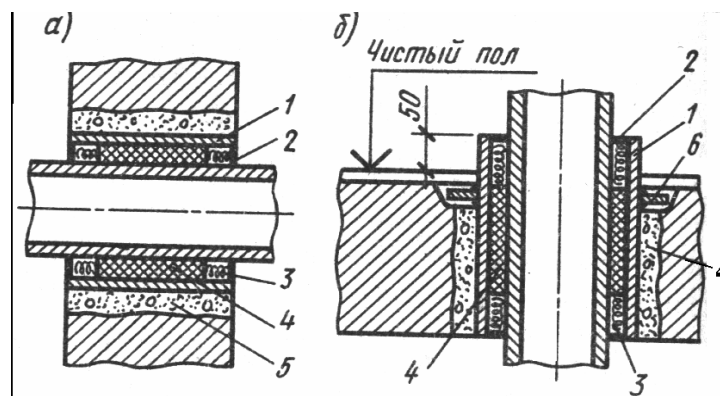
Футляры (гильзы) для прокладки газопроводов: а – через стены; б – через перекрытия; 1 – гильза; 2 – заделка битумом; 3 – битумизированная пакля; 4 – асбестовый шнур; 5 – цементный раствор; 6 – опорное кольцо
